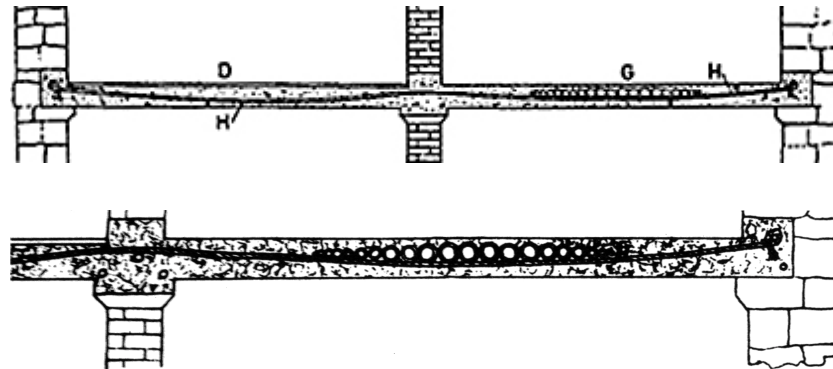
Construcción de pisos de losa de hormigón armado de acuerdo a las tensiones de tracción según Wilkinson. (Imagen tomada de [Ochshorn s.f.]).
